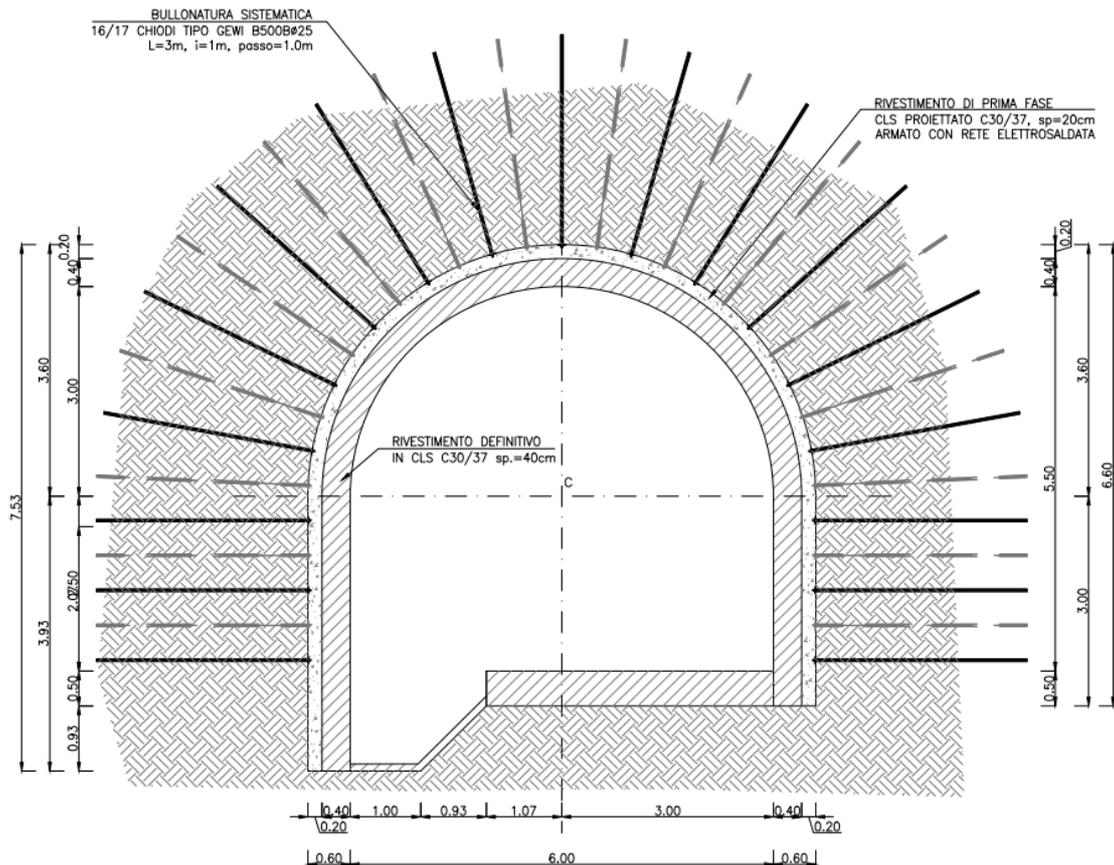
Sezione tipo della galleria ventilazione e cavi
